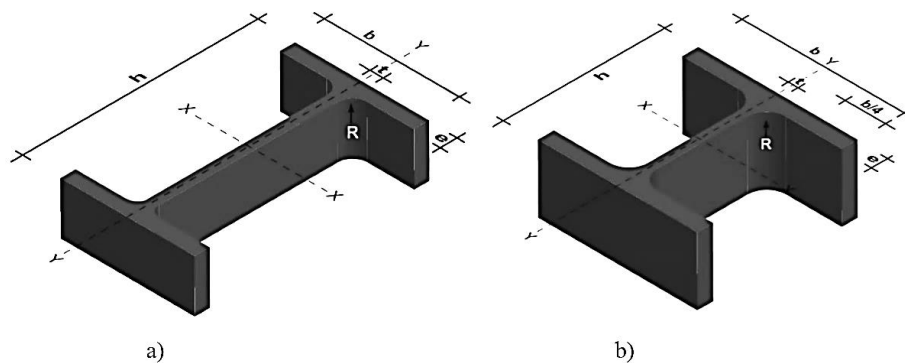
Perfil laminado a) IPE; b) HEB [14]
